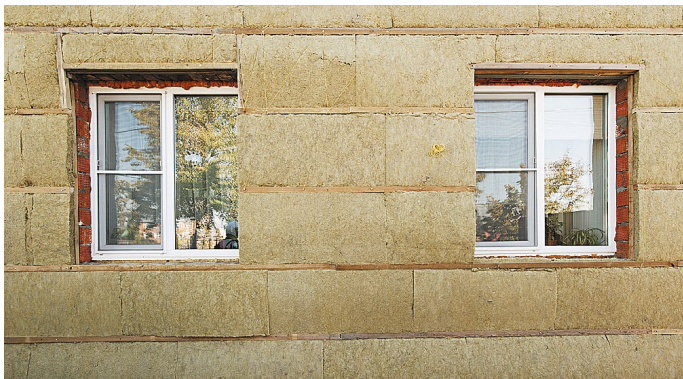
Монтаж теплоизоляционных плит в горизонтальный каркас
